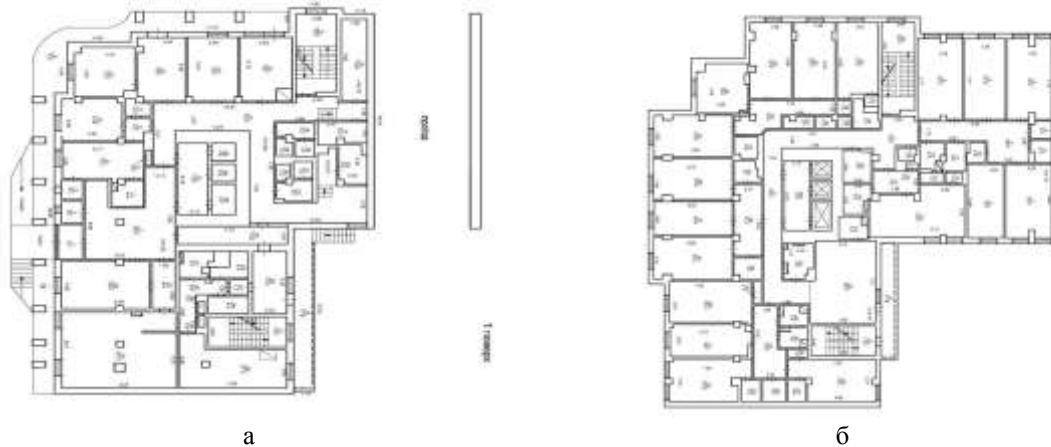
План будівлі: а) 1 поверх, б) 2-11 поверхи [5].
